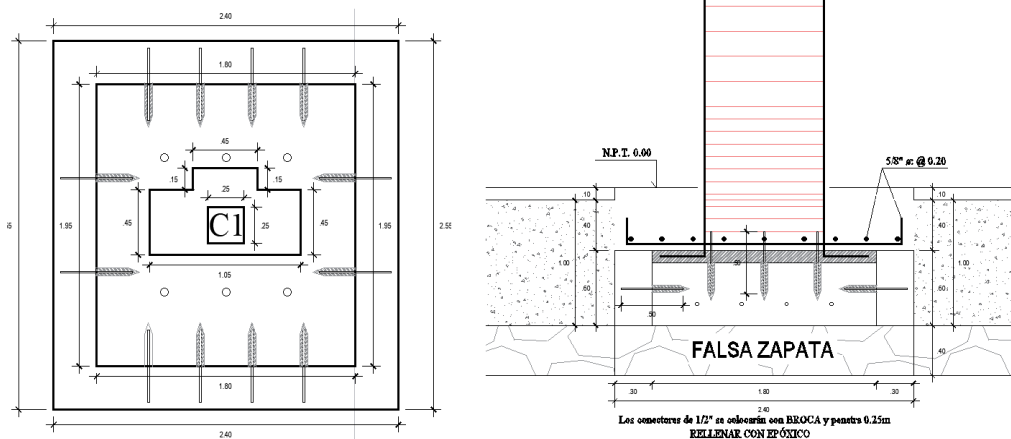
Corte y planta de zapata reforzada con anclajes y nuevos aceros según plan de reforzamiento 1.
